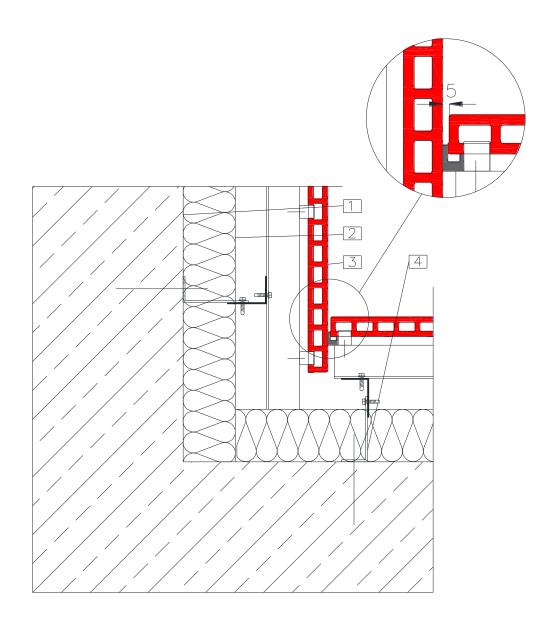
Angle rentrant – finition bardeaux Corner
